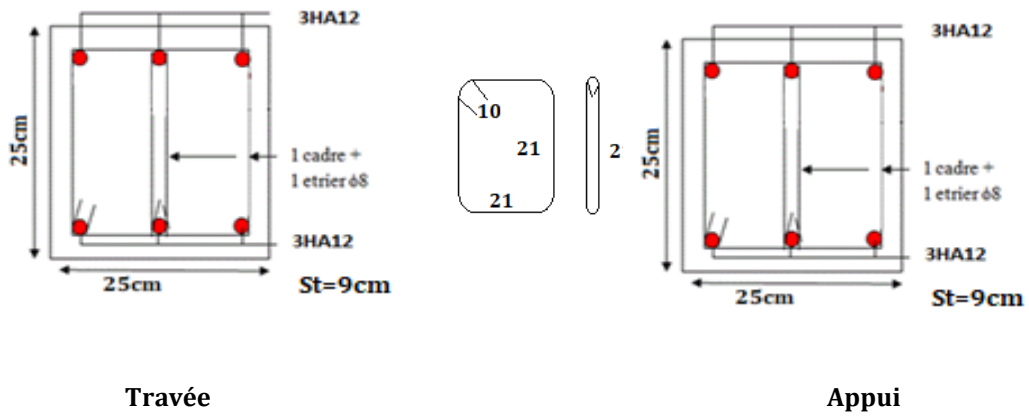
Schéma de ferrailage de la poutre principale de l'entresol au 9<sup>ème</sup>.
